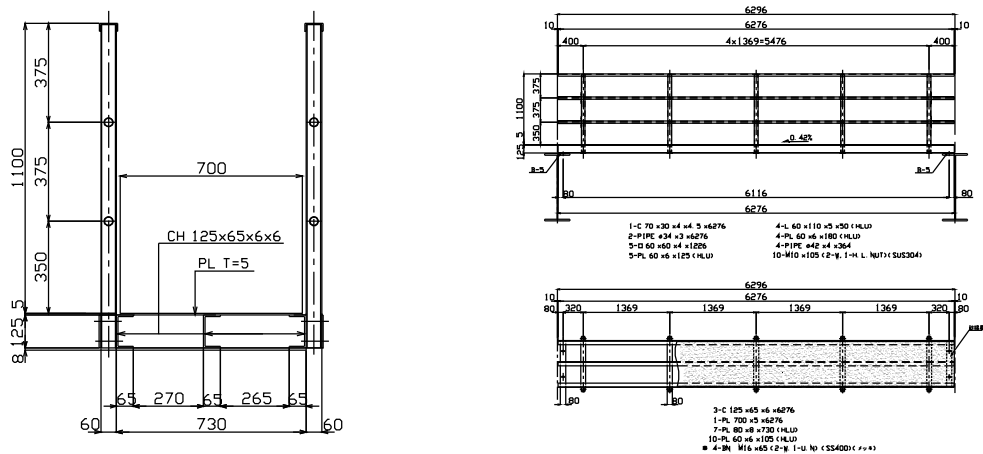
（仮称）駒瀬川橋FRP製検査路 詳細図
